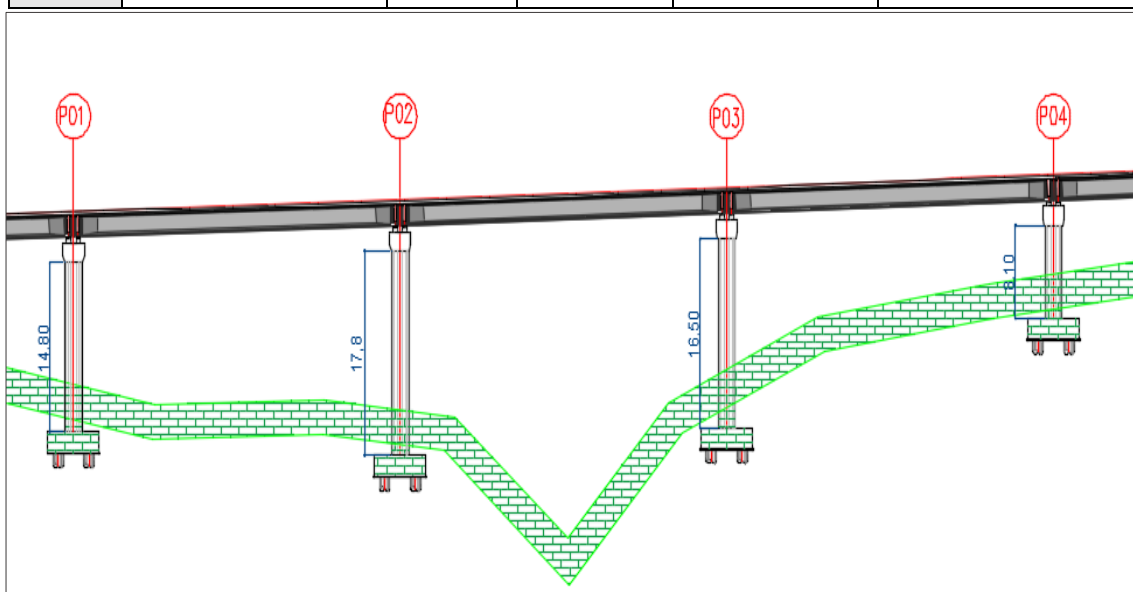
Coupe longitudinale et transversale de la pile.
